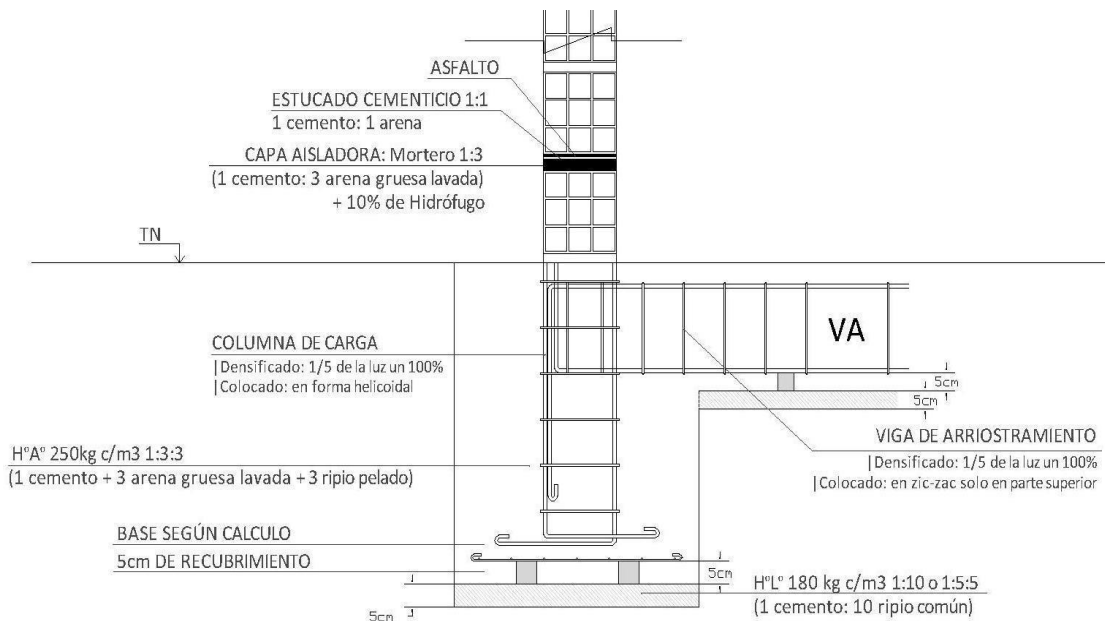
Detalle de unión de viga de arriostramiento con columna.
